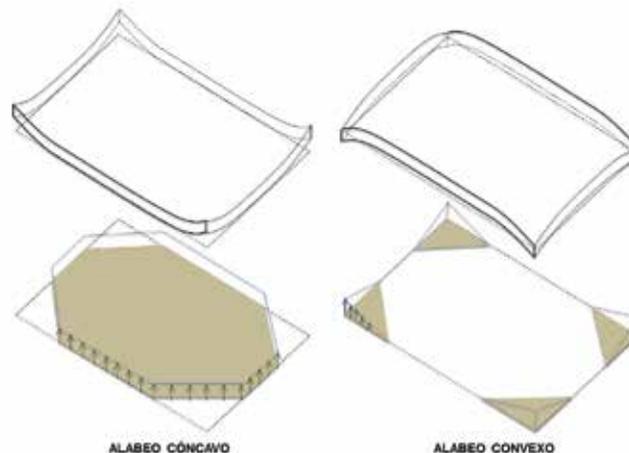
esquema de apoyo y distribución de cargas sobre la base para losas de pavimento alabeadas en forma cóncava y convexa respectivamente (Becker, 2015)[2].
